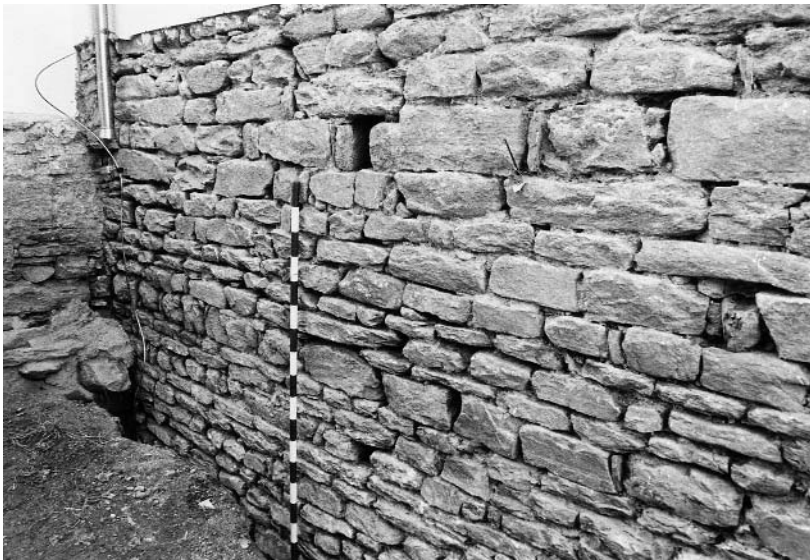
Cumbel 1996-99, Sogn Murezi. Ausschnitt der Nordfassade mit Mauerwerk des Vorgängerbaus. Foto von Nordwesten.
